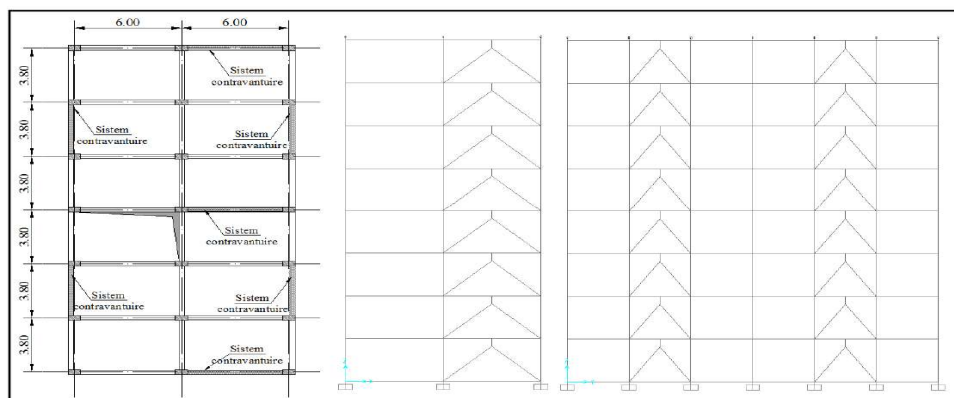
Amplasarea sistemelor de consolidare în plan și elevații.
